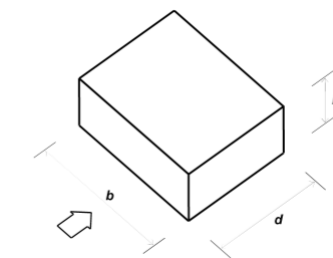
Parametri caratteristici di edifici a pianta rettangolare.
